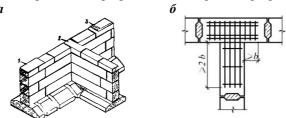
Перевязка блоков продольных и поперечных стен подвала: a – перевязка блоков; δ – усиление примыкания арматурными сетками; 1 – выровненная поверхность стены подвала; 2 – перевязка блоков; 3 – гидроизоляция.
